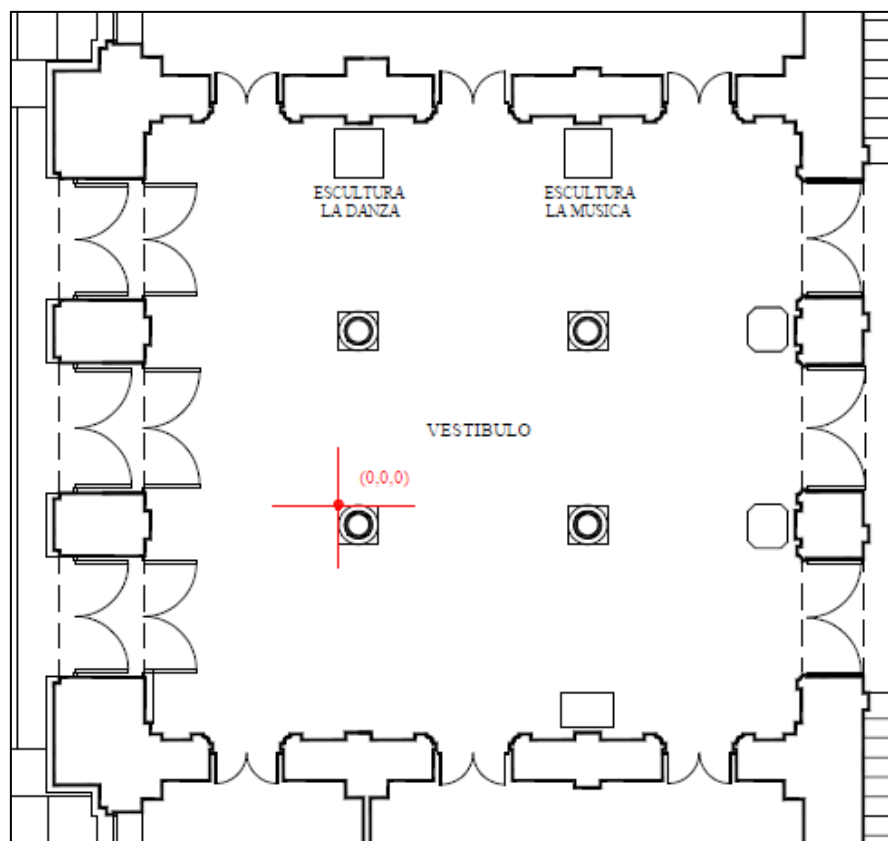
Detalle del vestíbulo con el punto de coordenadas
